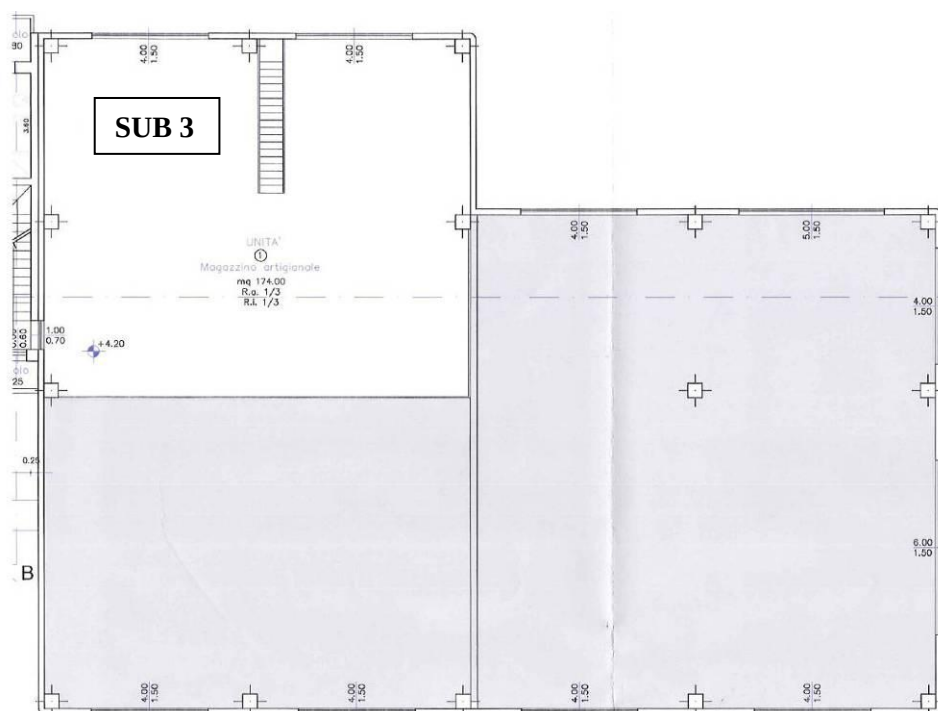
Estratto tavola DIA 818/08 – Planimetria Piano Primo capannone – parte soppalcata
